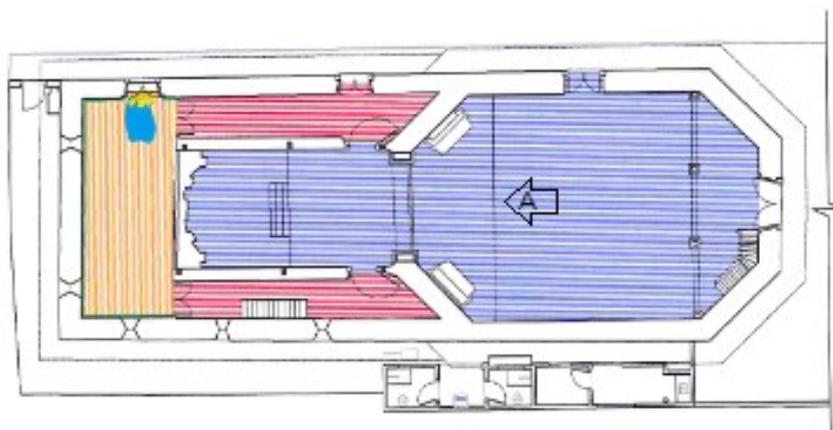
Vista A - Capela-mor - Planta pavimento inferior Capela do Pilar. Sem escala.
